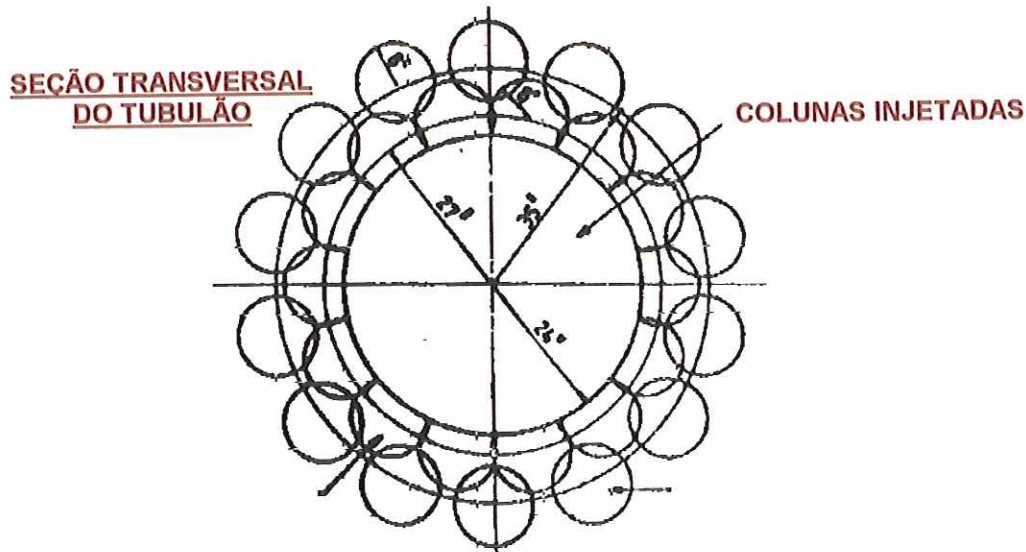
Planta da Zona de Melhoria com o Uso de Colunas Injetadas (TING & TOH, 1985).
